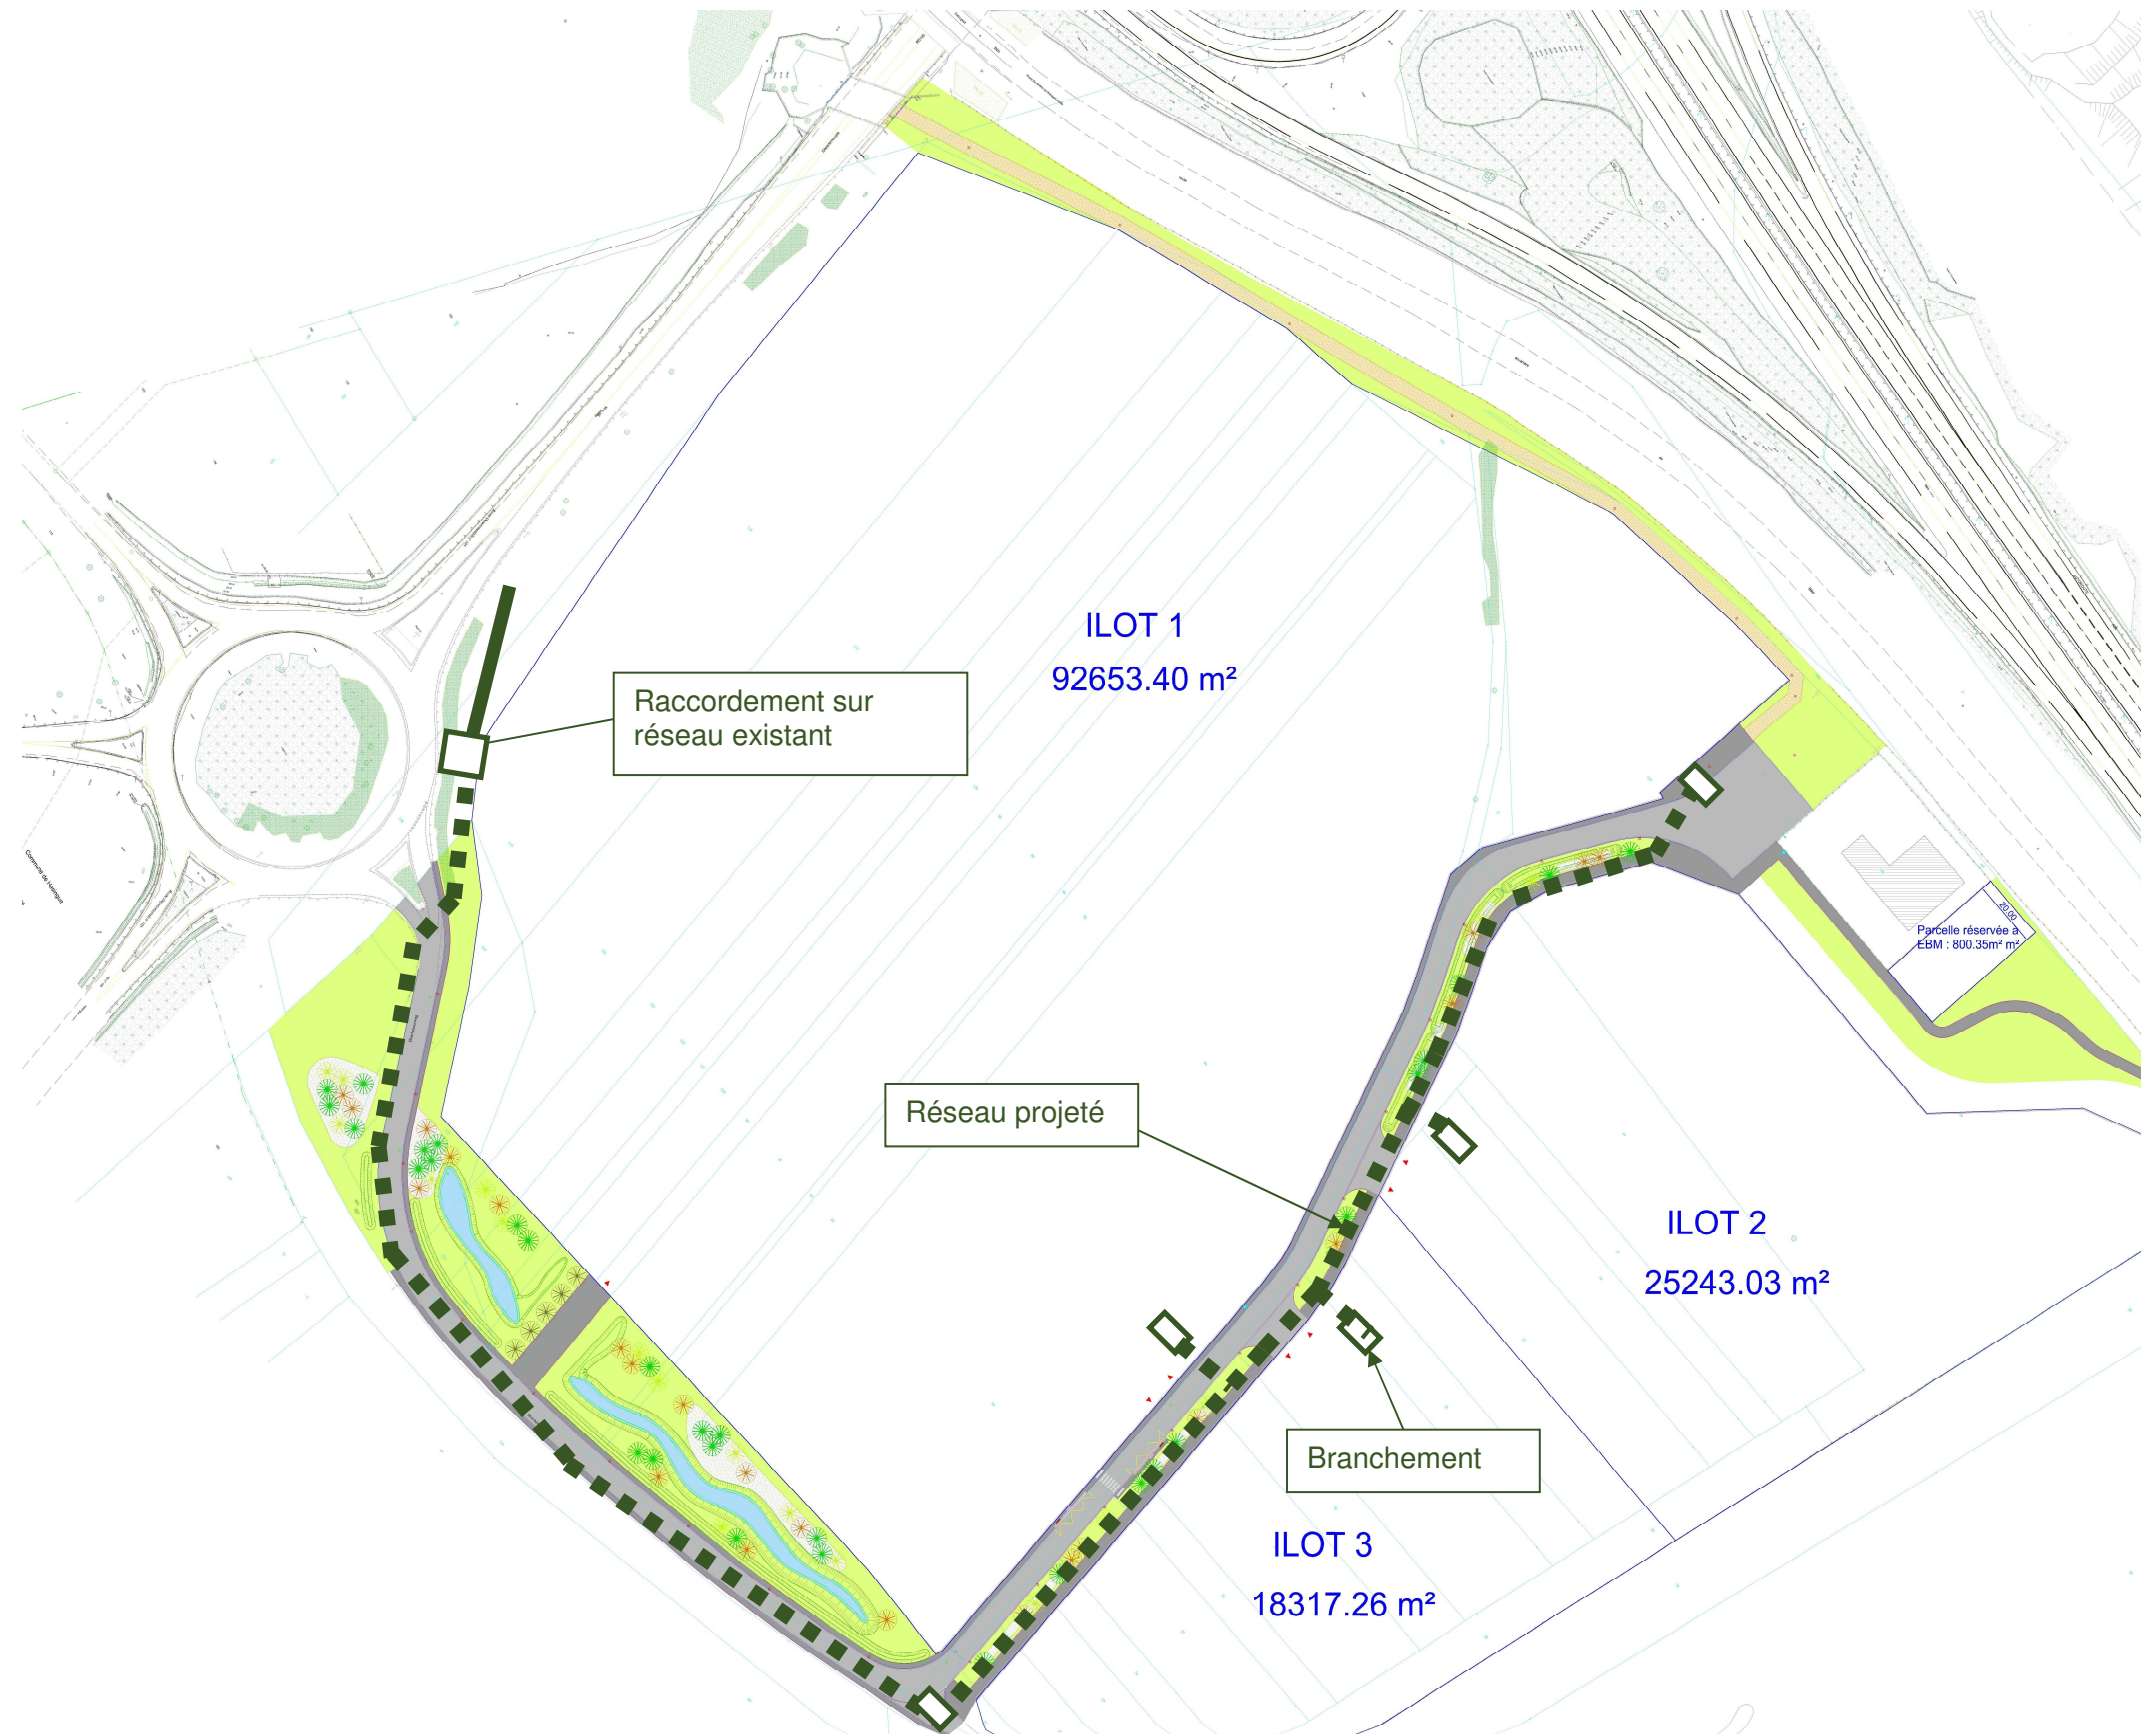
Plan du réseau Téléphonie câblage de la ZAC
